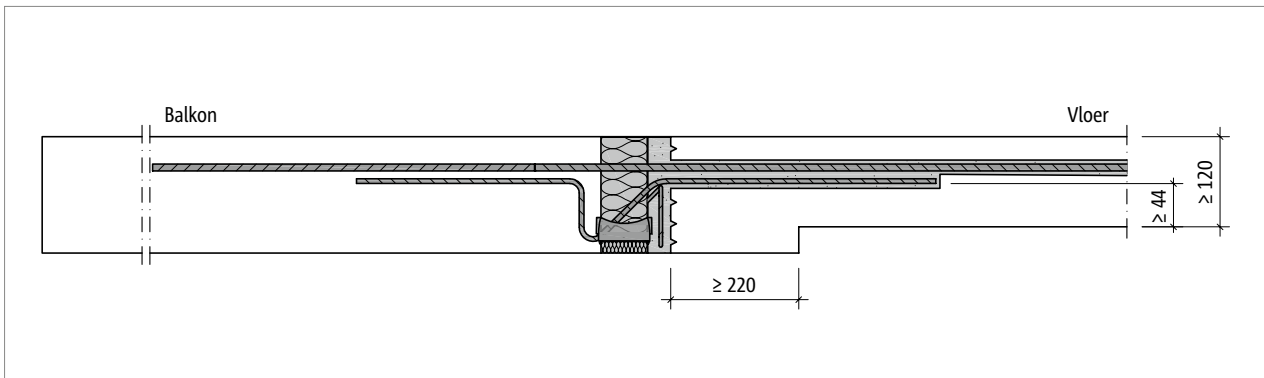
Schöck Isokorb® RT type K: Vrij uitragend balkon bij vernieuwing van bestaand balkon
